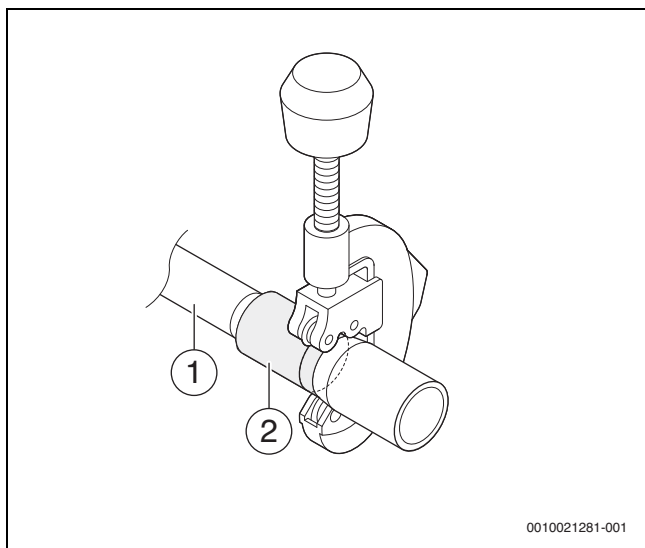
Cortar el tubo bifurcado en la parte inferior
